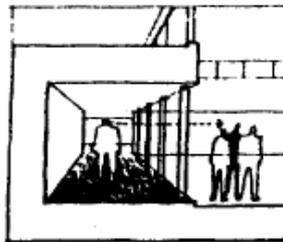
Skema Bentuk Ruang Sirkulasi Tertutup.
